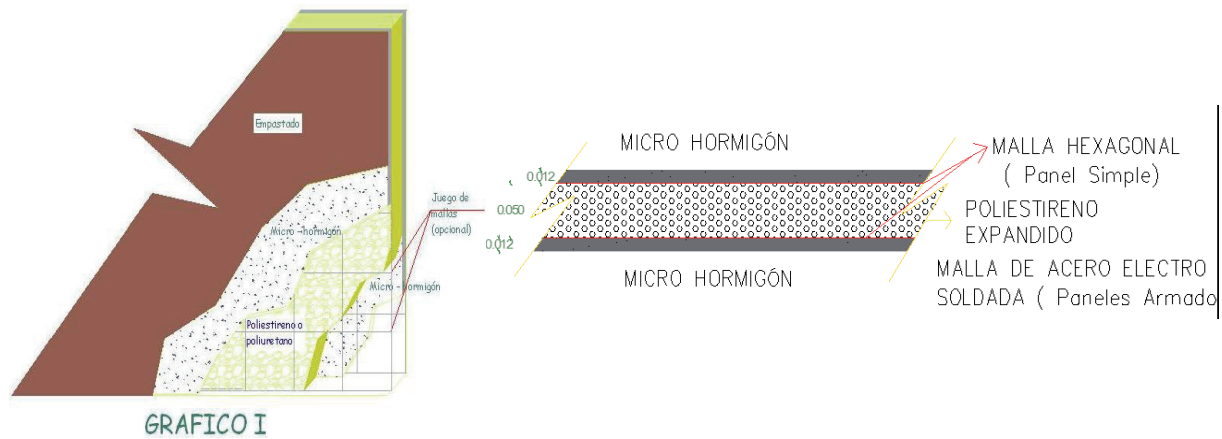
Estructura Celular del Panel Vista en Planta 2D.
